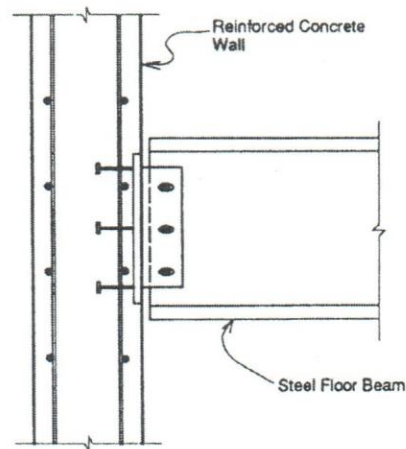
Conexión de apoyo simple entre viga de acero y muro de concreto reforzado²¹
